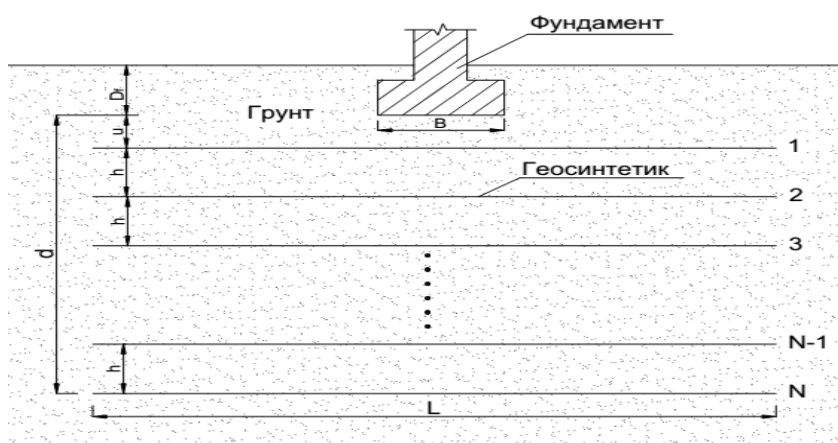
Параметры фундамента из геосинтетического армированного грунта. b – ширина фундамента; D_f – глубина фундамента; u – расстояние между верхними слоями или глубина до первого слоя армирования; h – расстояние между армирующими слоями по вертикали; d – общая глубина армирования; N – количество армирующих слоев; L – длина армирующих материалов.
